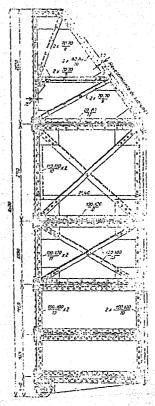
COMPUERTA DE ACERO, ARMA DA CON PLANCHAS Y VIGUETAS DEL MISMO. (SCHOKLITSCH)
